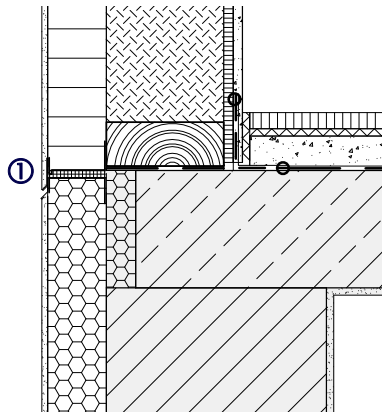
Gebäude mit Betondecke und durchgängigem Wärmedämm-Verbundsystem
